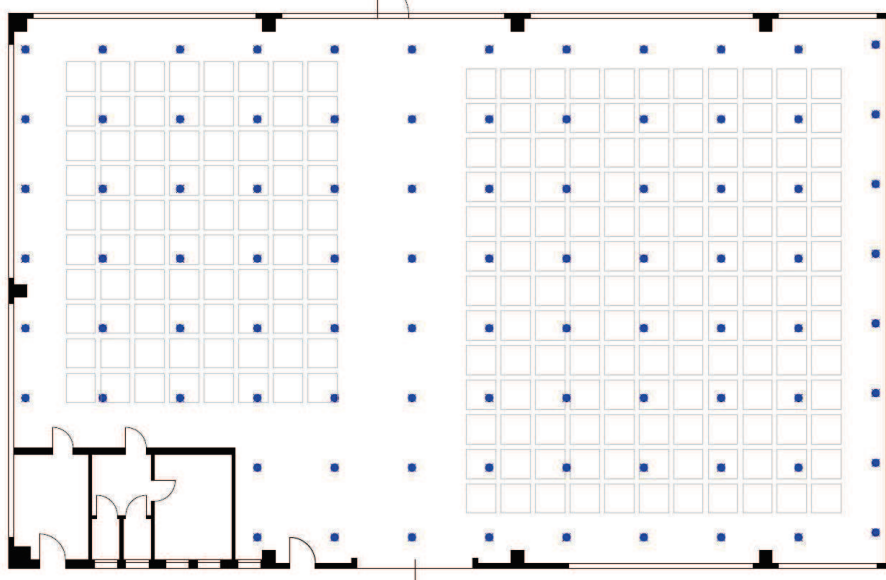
Planimetria esemplificativa della disposizione delle testine che costituiscono il sistema di spegnimento sprinkler.
